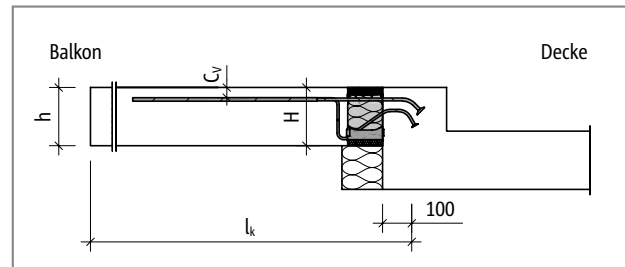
Schöck Isokorb® XT Typ KL-O: Statisches System
